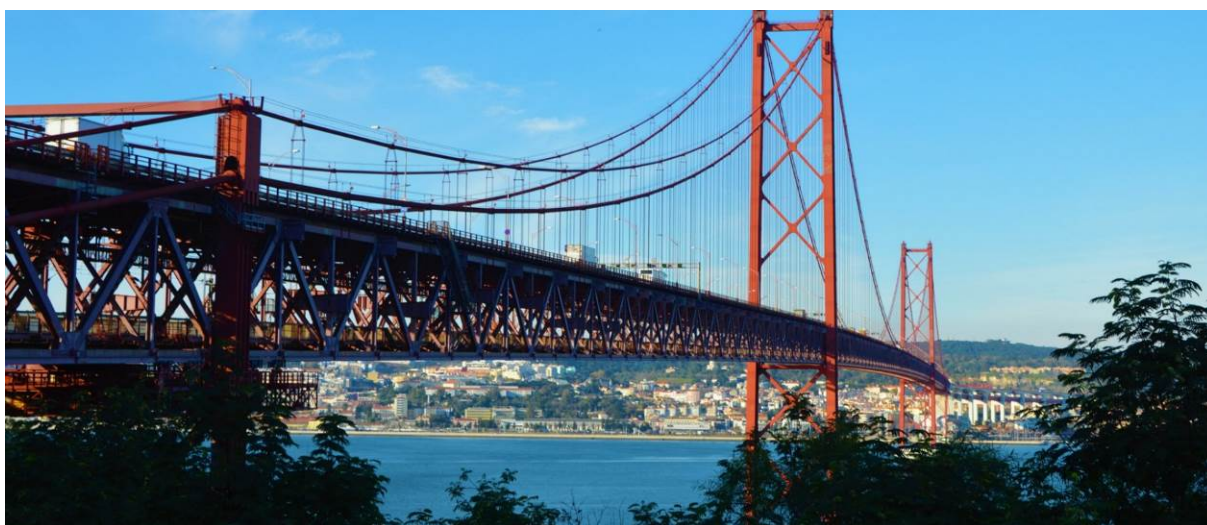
Vista da Ponte 25 de Abril, do lado de Almada para Lisboa, vendo-se a ponte metálica suspensa e, ao fundo, o viaduto de acesso norte, em betão²
